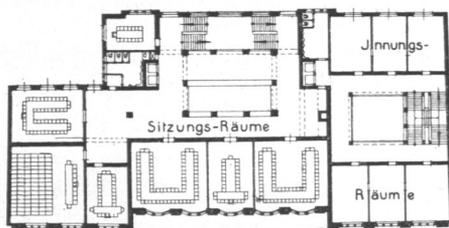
Gewerbehaus, 2. Obergeschoß, Grundriß.
